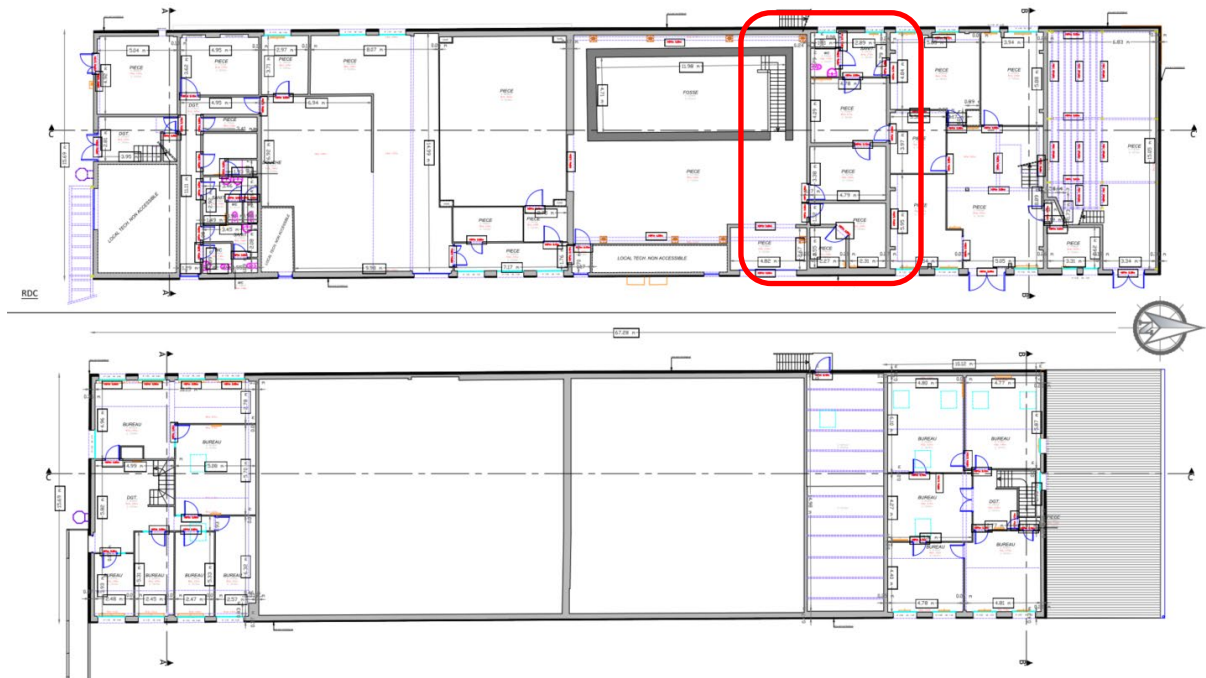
Plan existant géomètre du RDC (en haut) et R+1 (en bas) - Zone d'étude en rouge
